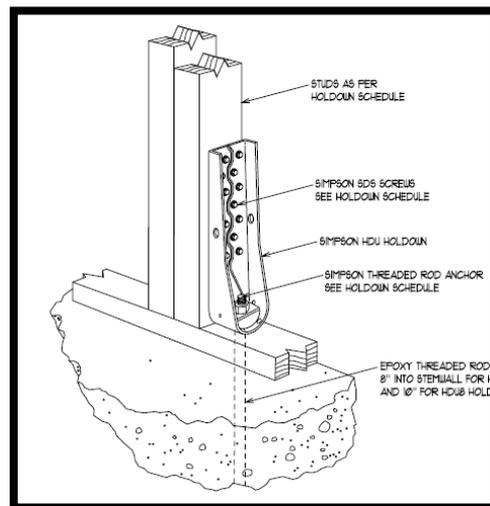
Detalle típico Holdown. Fuente: Structural drawings. “Providence Hall High School”.
